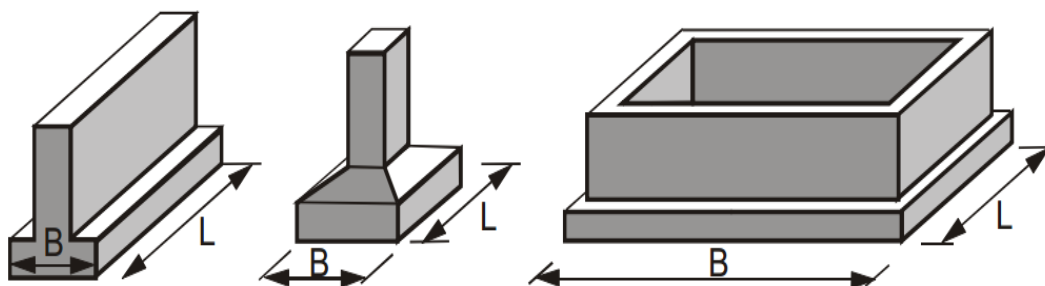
Types de fondations superficielles (Frank, 1999).
